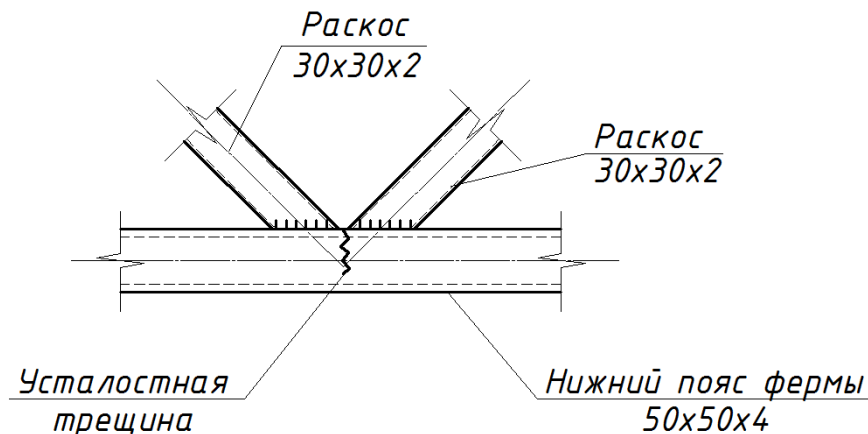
Усталостная трещина в нижнем поясе фермы
